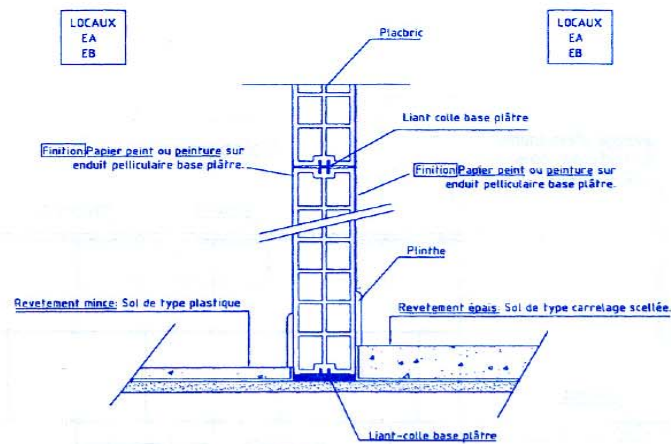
Pied PLACBRIC séparant locaux EA/EB de locaux EA/EB
